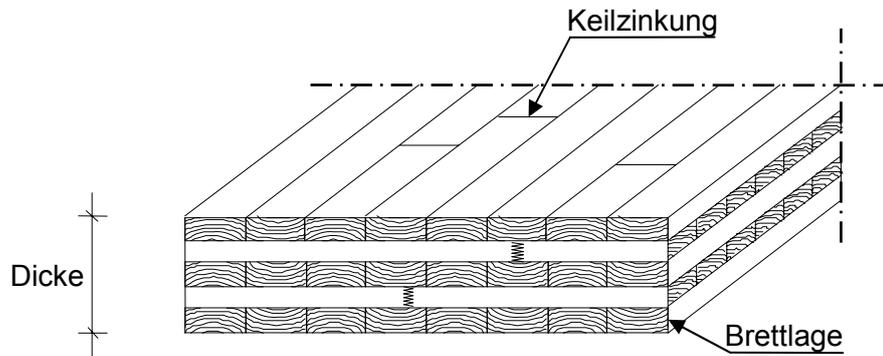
Grundsätzlicher Aufbau eines Brettspertholzelements (fünf Lagen)
